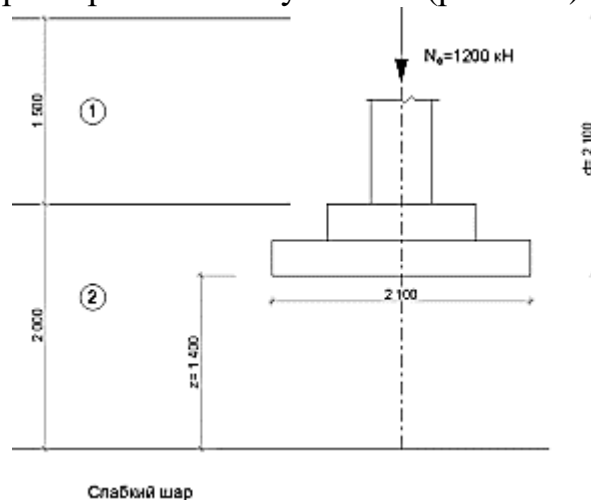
Розміщення фундаменту в ґрунті
